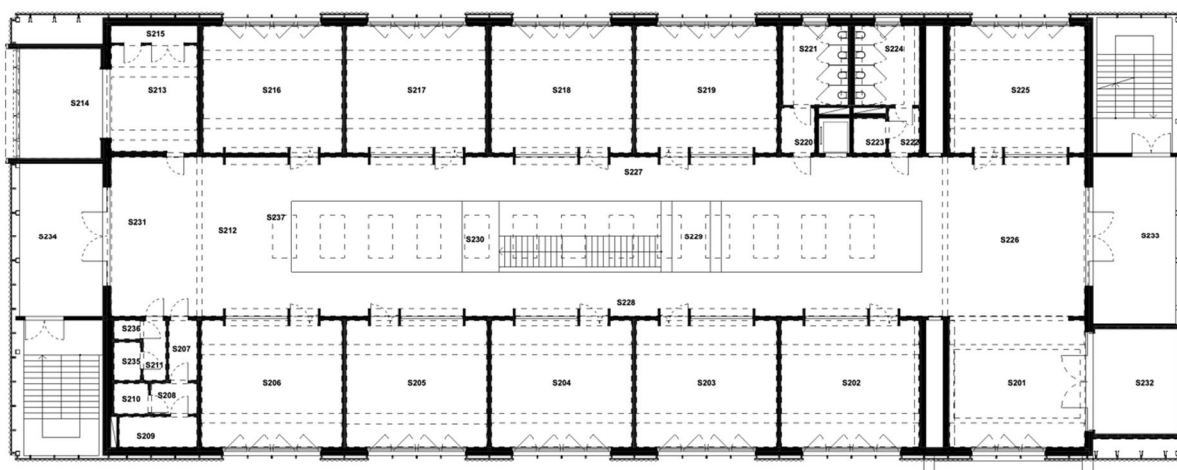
Pianta piano secondo con indicazione delle facciate su cui verranno eseguite le verifiche di isolamento standardizzato di facciata_SCUOLA
